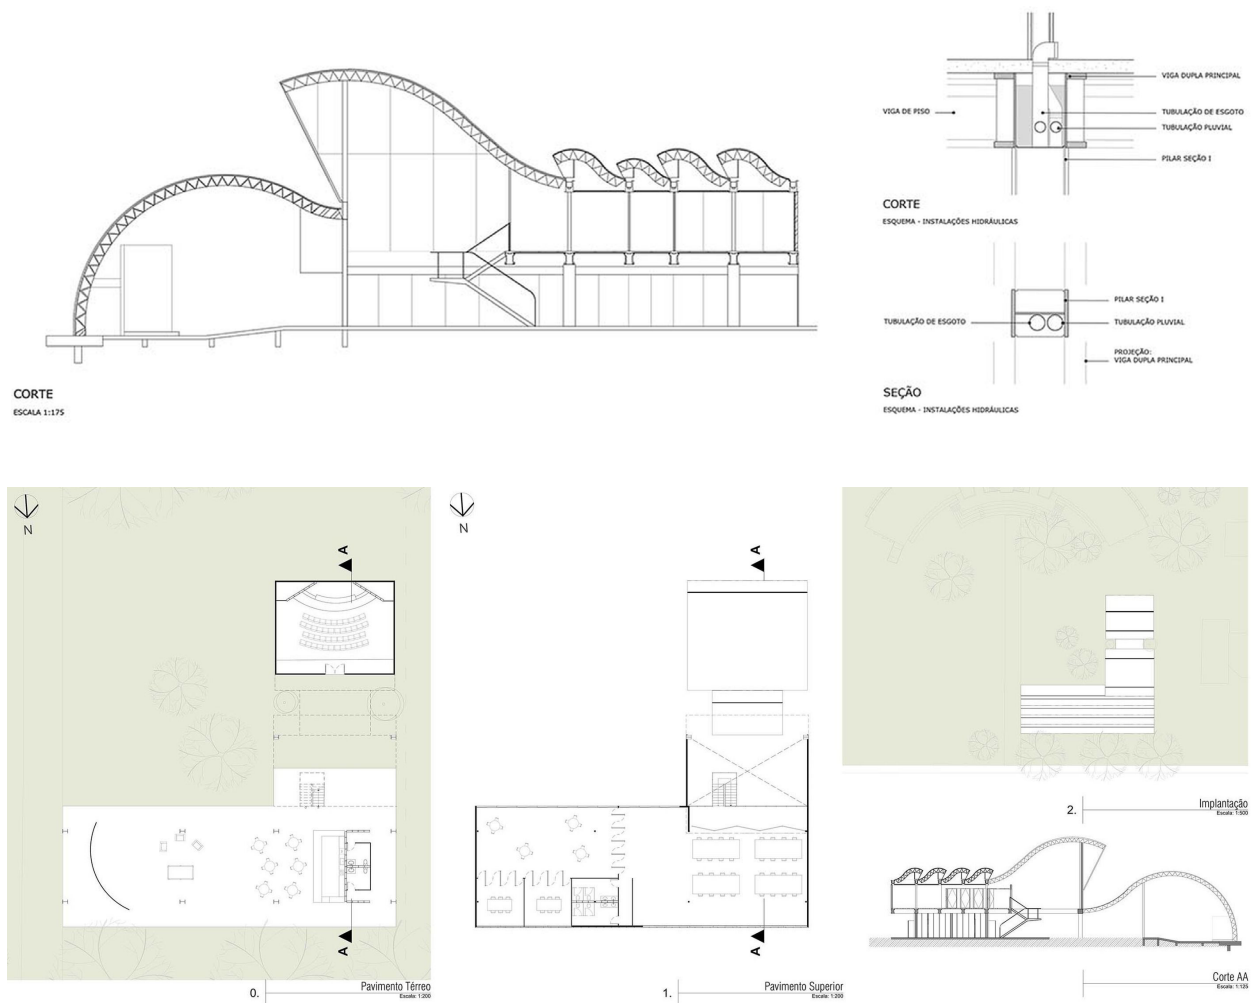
Recorte da prancha de análise do edifício-sede do TCU em Vitória desenvolvida pelo grupo 9⁴, com destaque para o corte transversal e a junção entre pilar e viga de aço. Fonte: os autores.
